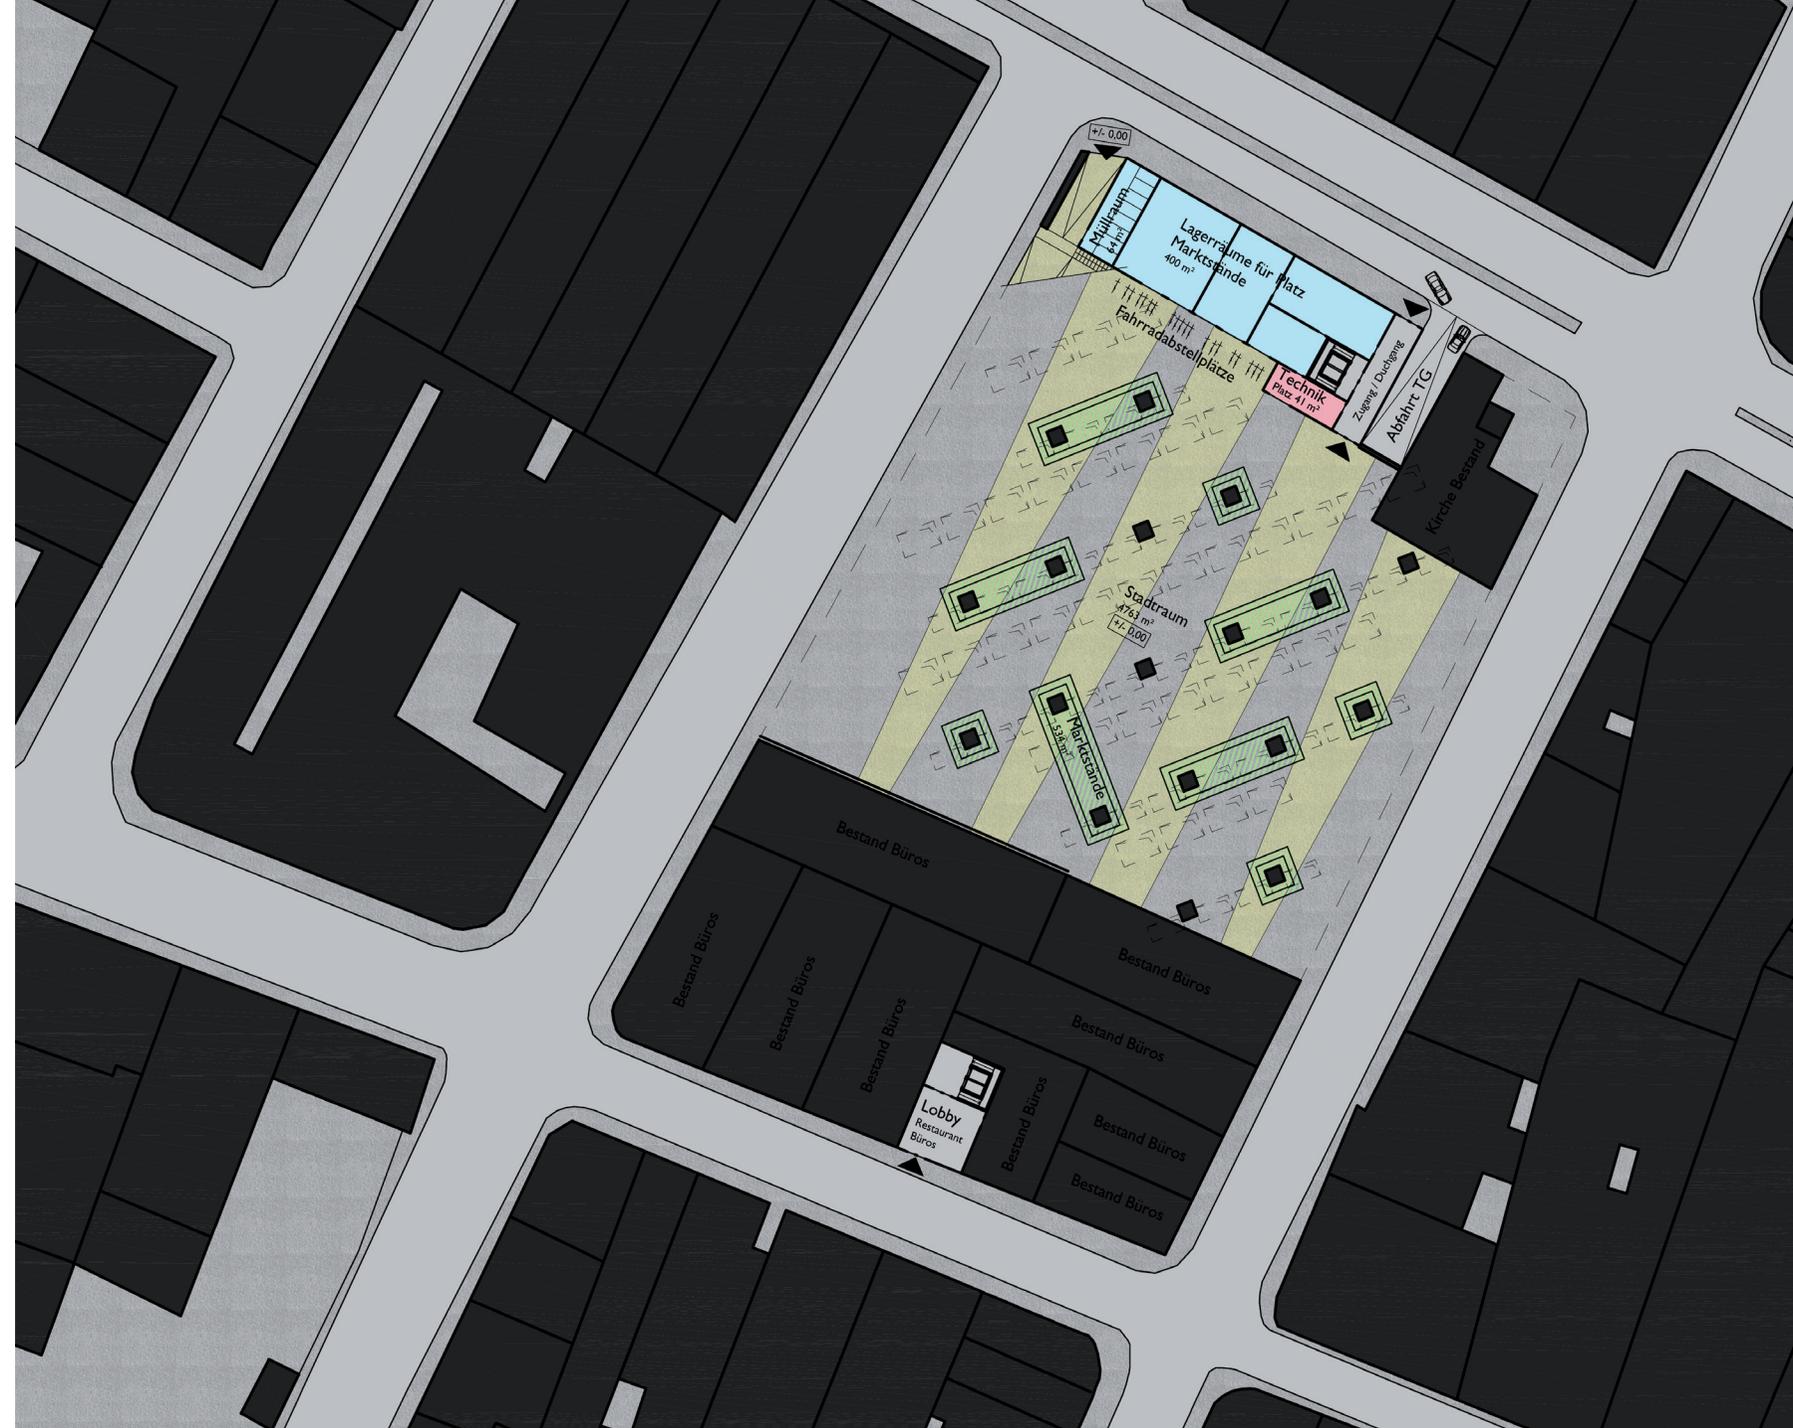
Grundriss Rampe, M=1:1000, genordet. ▶
